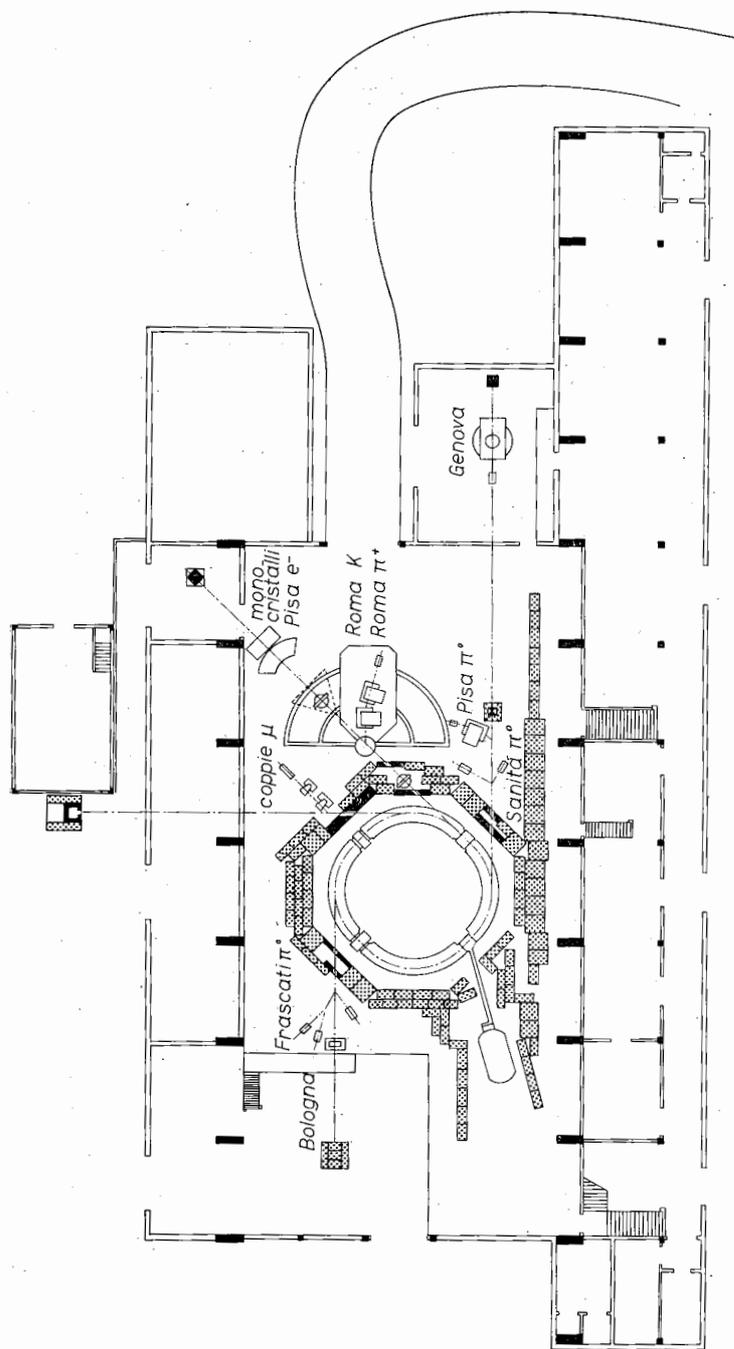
Pianta dell'edificio sincrotrone.
